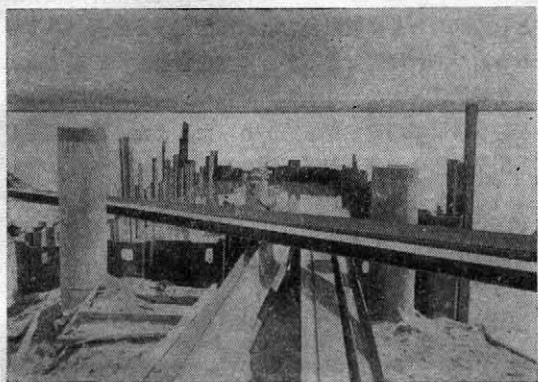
呑口部施工中 (手前のパイルは鋼管のビヤ)
